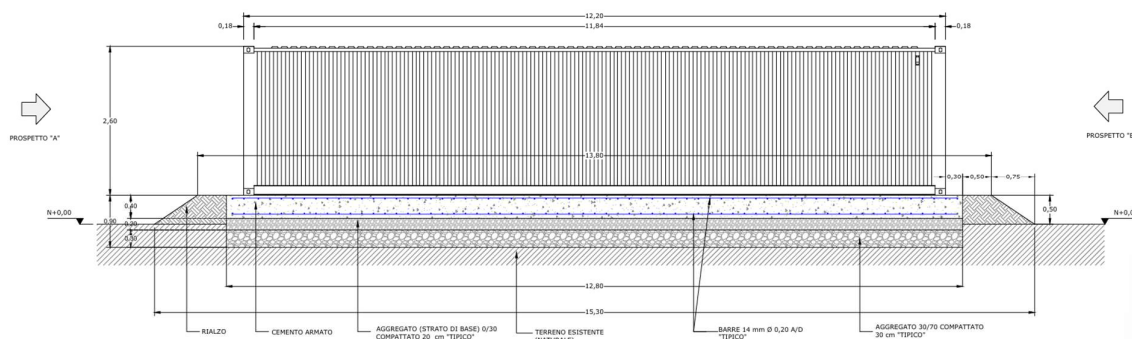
Rappresentazione Fondazione e Cabina di Stoccaggio.
